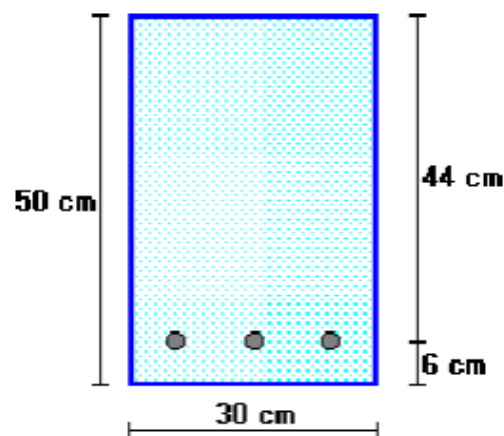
Ejemplo de viga compuesta (Viga de hormigón armado).
